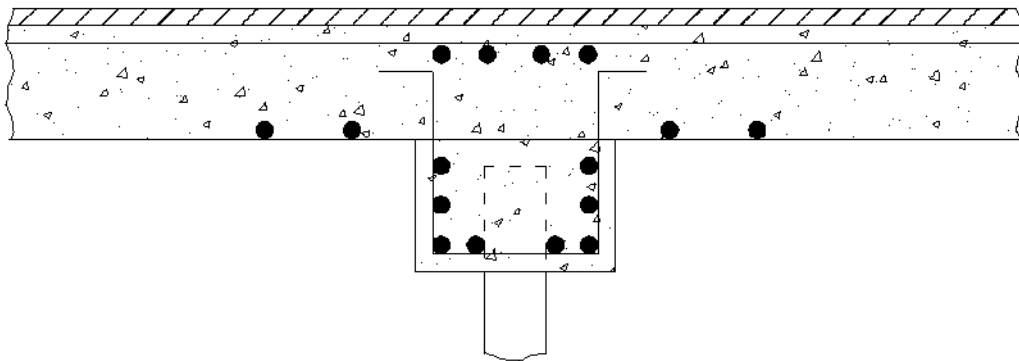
Pile Cap Bents With Drop Panel Reinforcement
